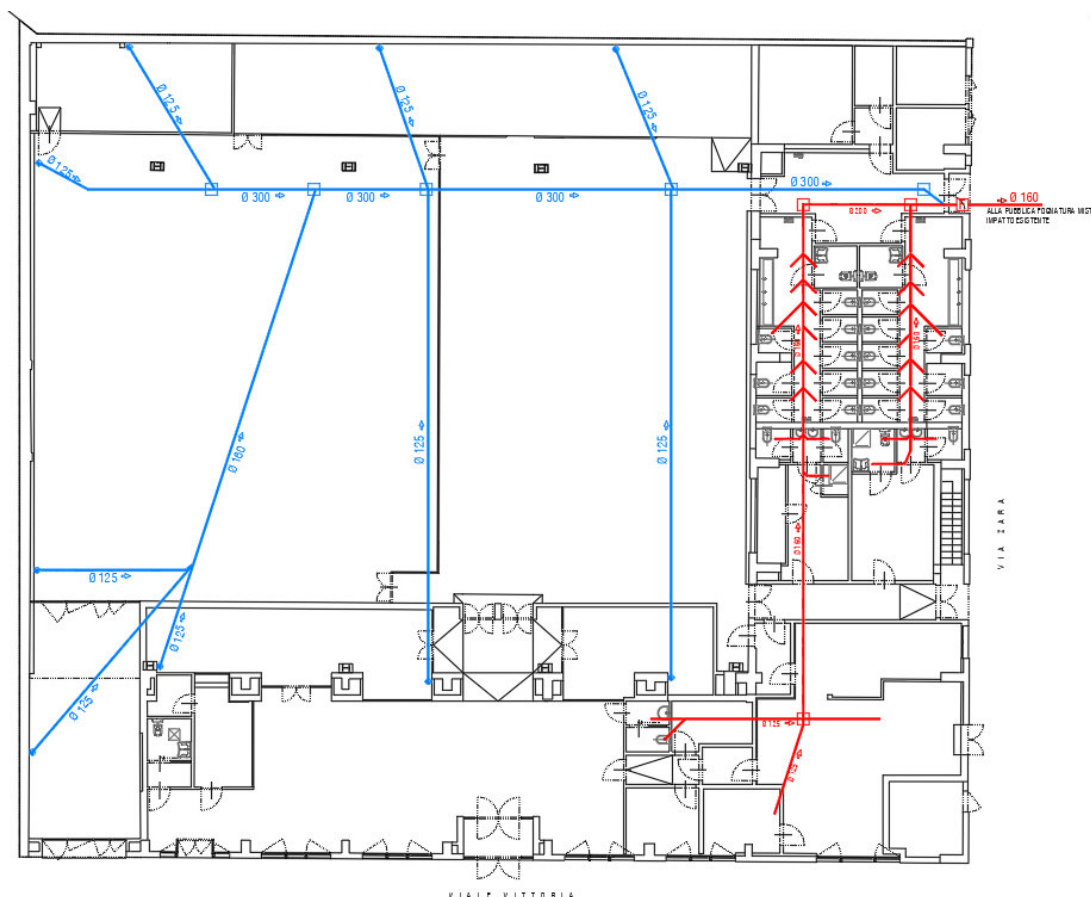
Planimetria delle reti fognarie nello stato attuale.
